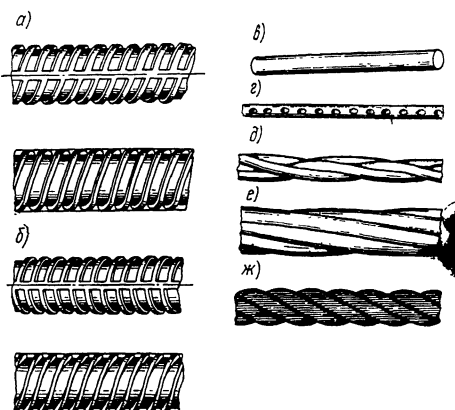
Арматура, применяемая для устройства железобетонных конструкций
